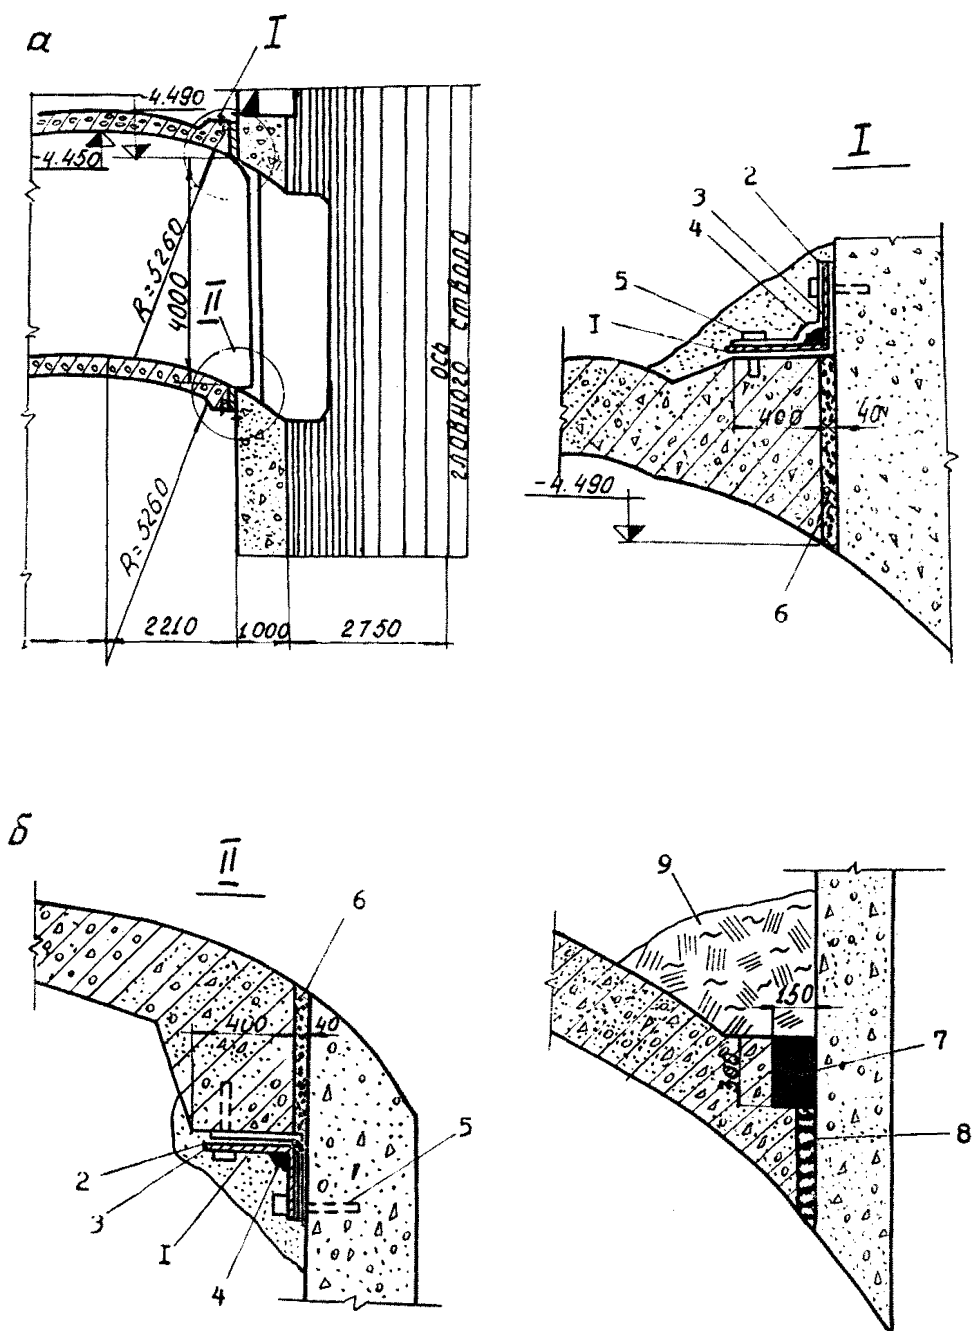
Герметизация мест примыкания вентиляционных каналов к стволу (А) и сопряжение вентиляционных каналов (Б):
